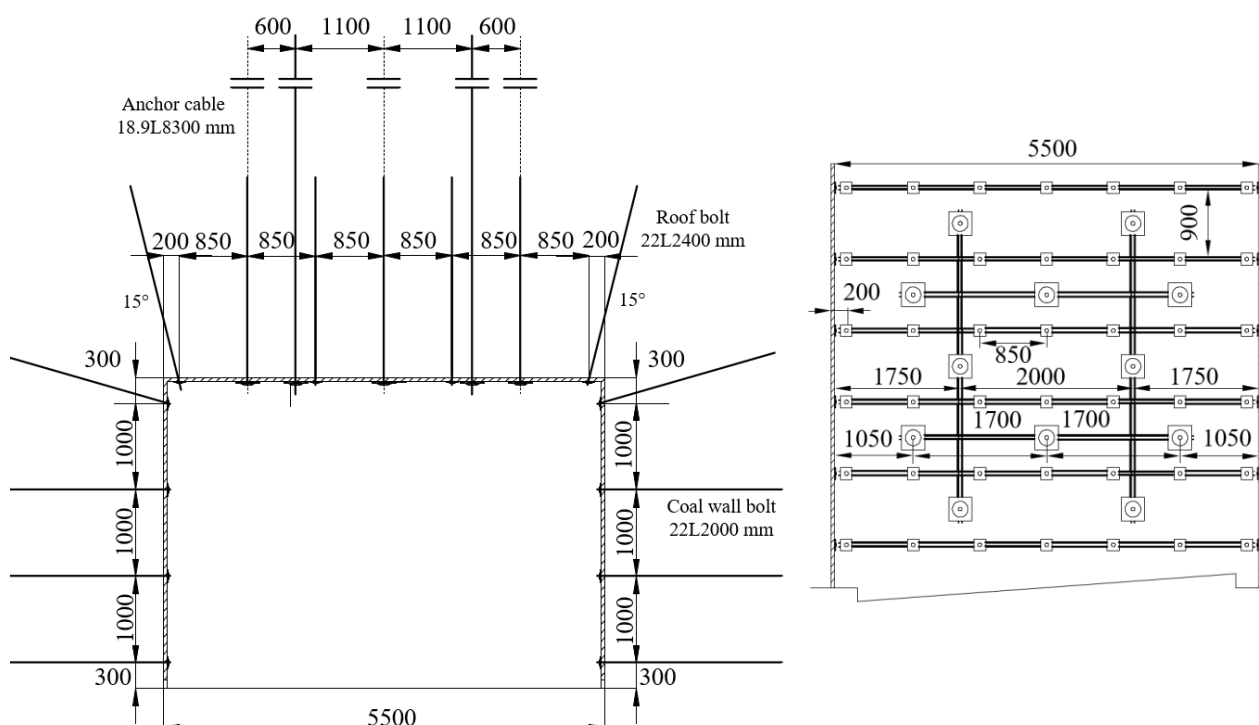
Основная крепь вентиляционного штрека 91-101. (а) Сечение выработки; (б) Кровля выработки
